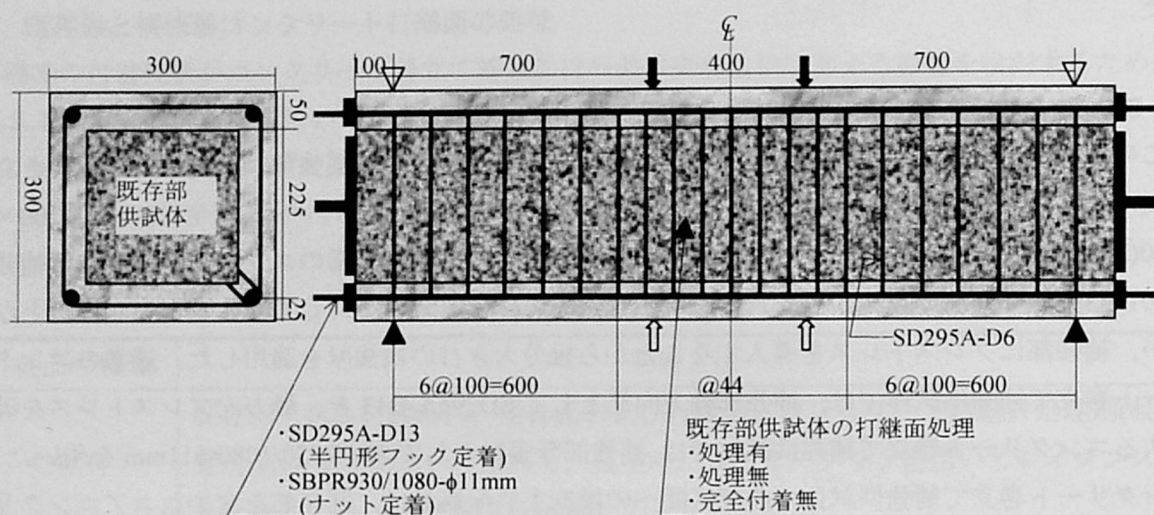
コンクリート巻立て補強供試体形状・寸法 (単位:mm)
